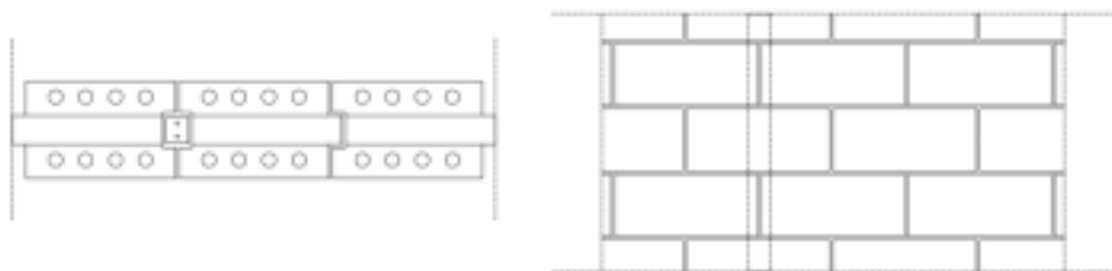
Elevação de parede realizada com blocos de encaixe de baixo carbono, moldes de construção de blocos em chapa metálica e em madeira. Blocos concebidos pelo Prof. Doutor. Arqt. Reaes Pinto. (Ilustração nossa, 2020).
